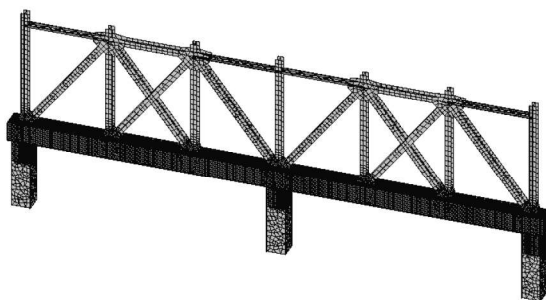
Расчетная схема нижнего пояса для расчета по методу № 6
